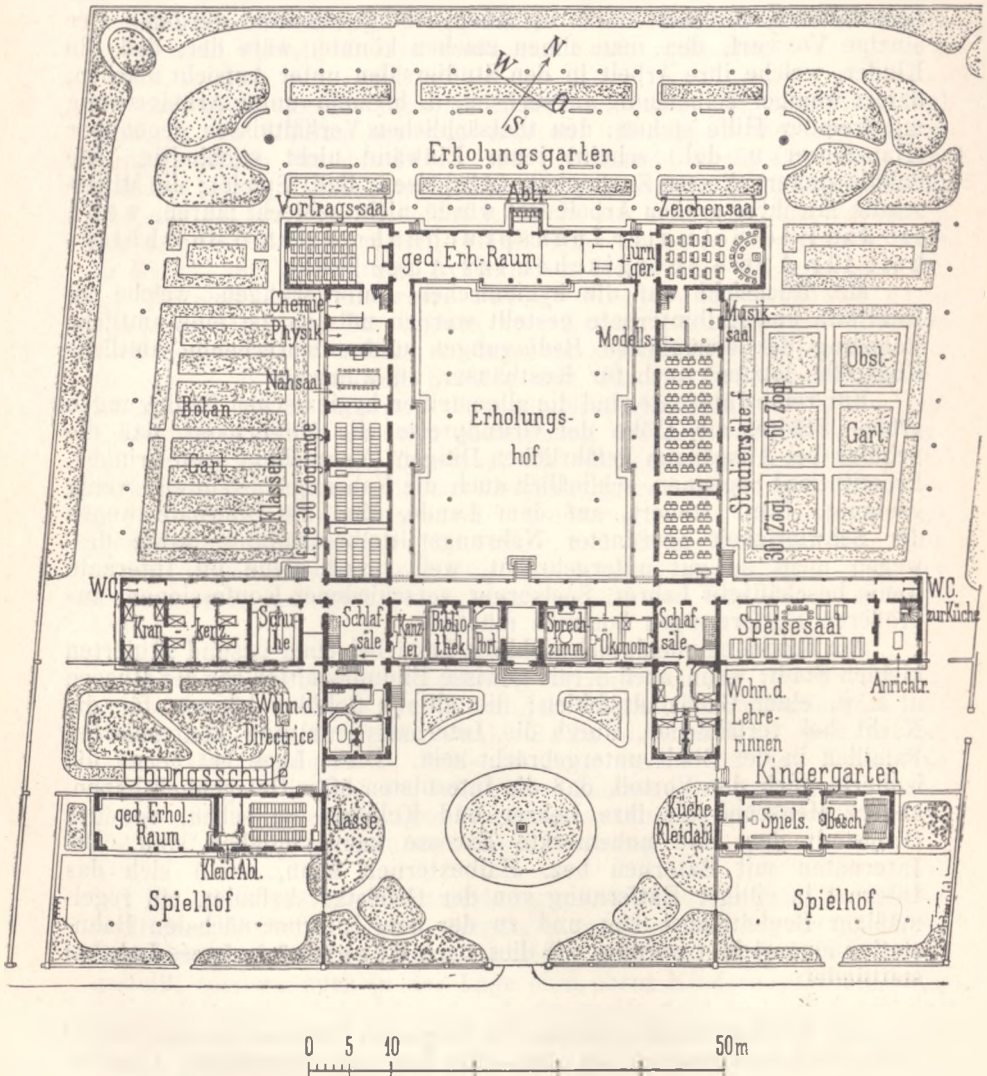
Lehrerinnenbildungsanstalt zu Auxerre, Deptmt. Yonne. Situationsplan und Grundriß des Erdgeschosses. Nach Bréasson.
